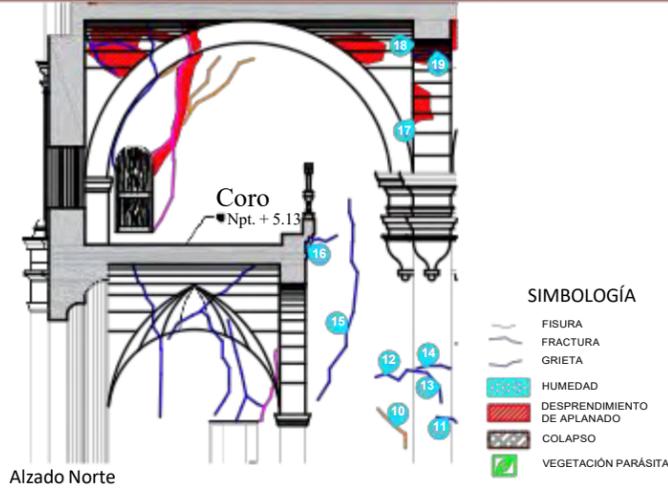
Detalle de afectaciones en parte alta de muro interior norte
